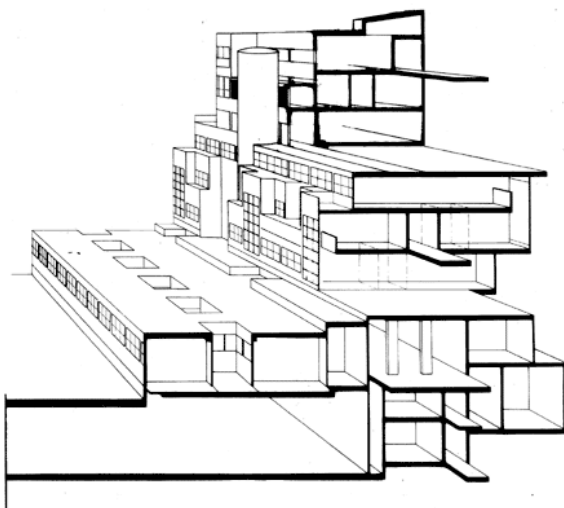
Spaccato assonometrico e sezione tipo di una delle stecche residenziali
